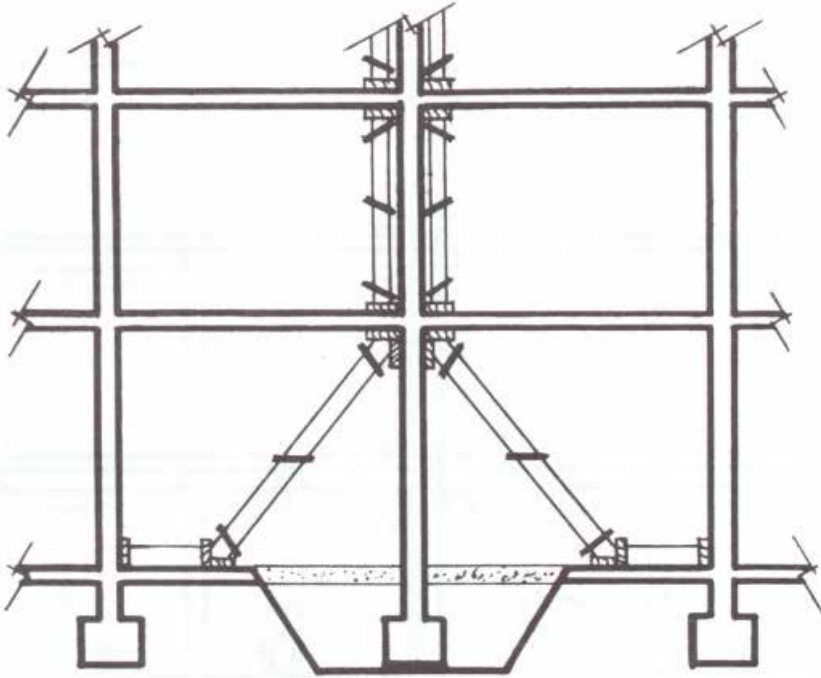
Detalle apeo cimentación para su refuerzo. Ed. Munilla-Leira.
